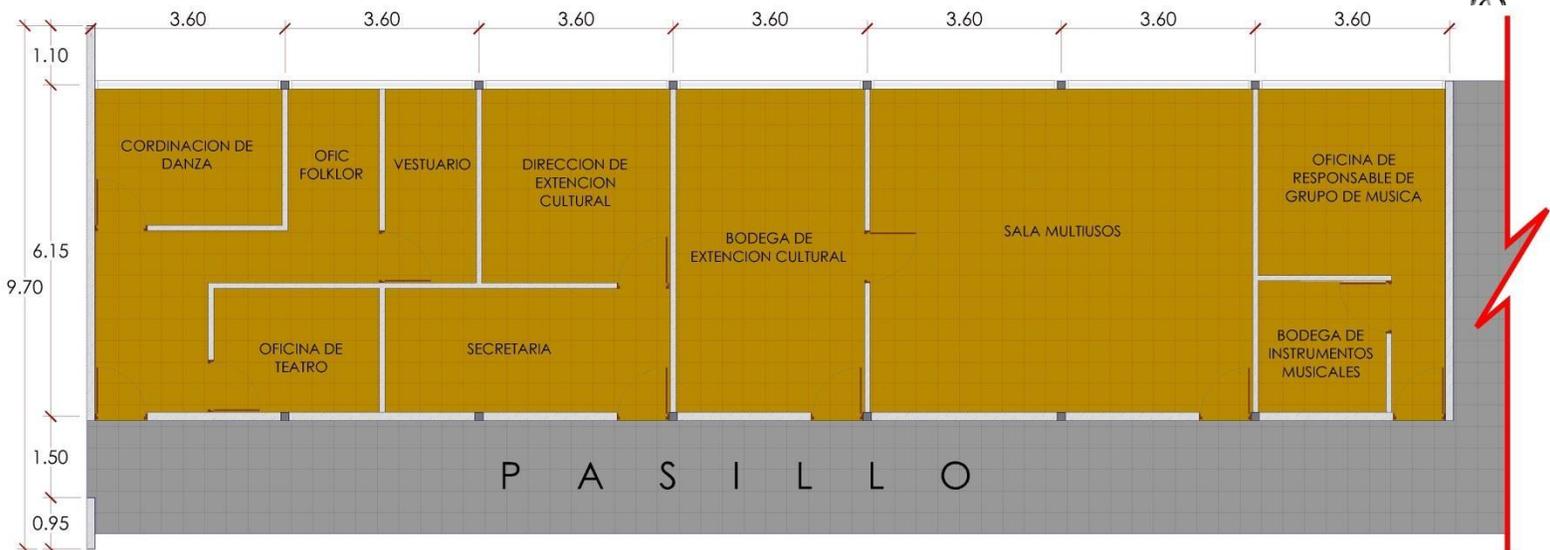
Planta Arquitectónica. Departamento de Extensión Cultural. Modulación. // Fuente: Propia.
